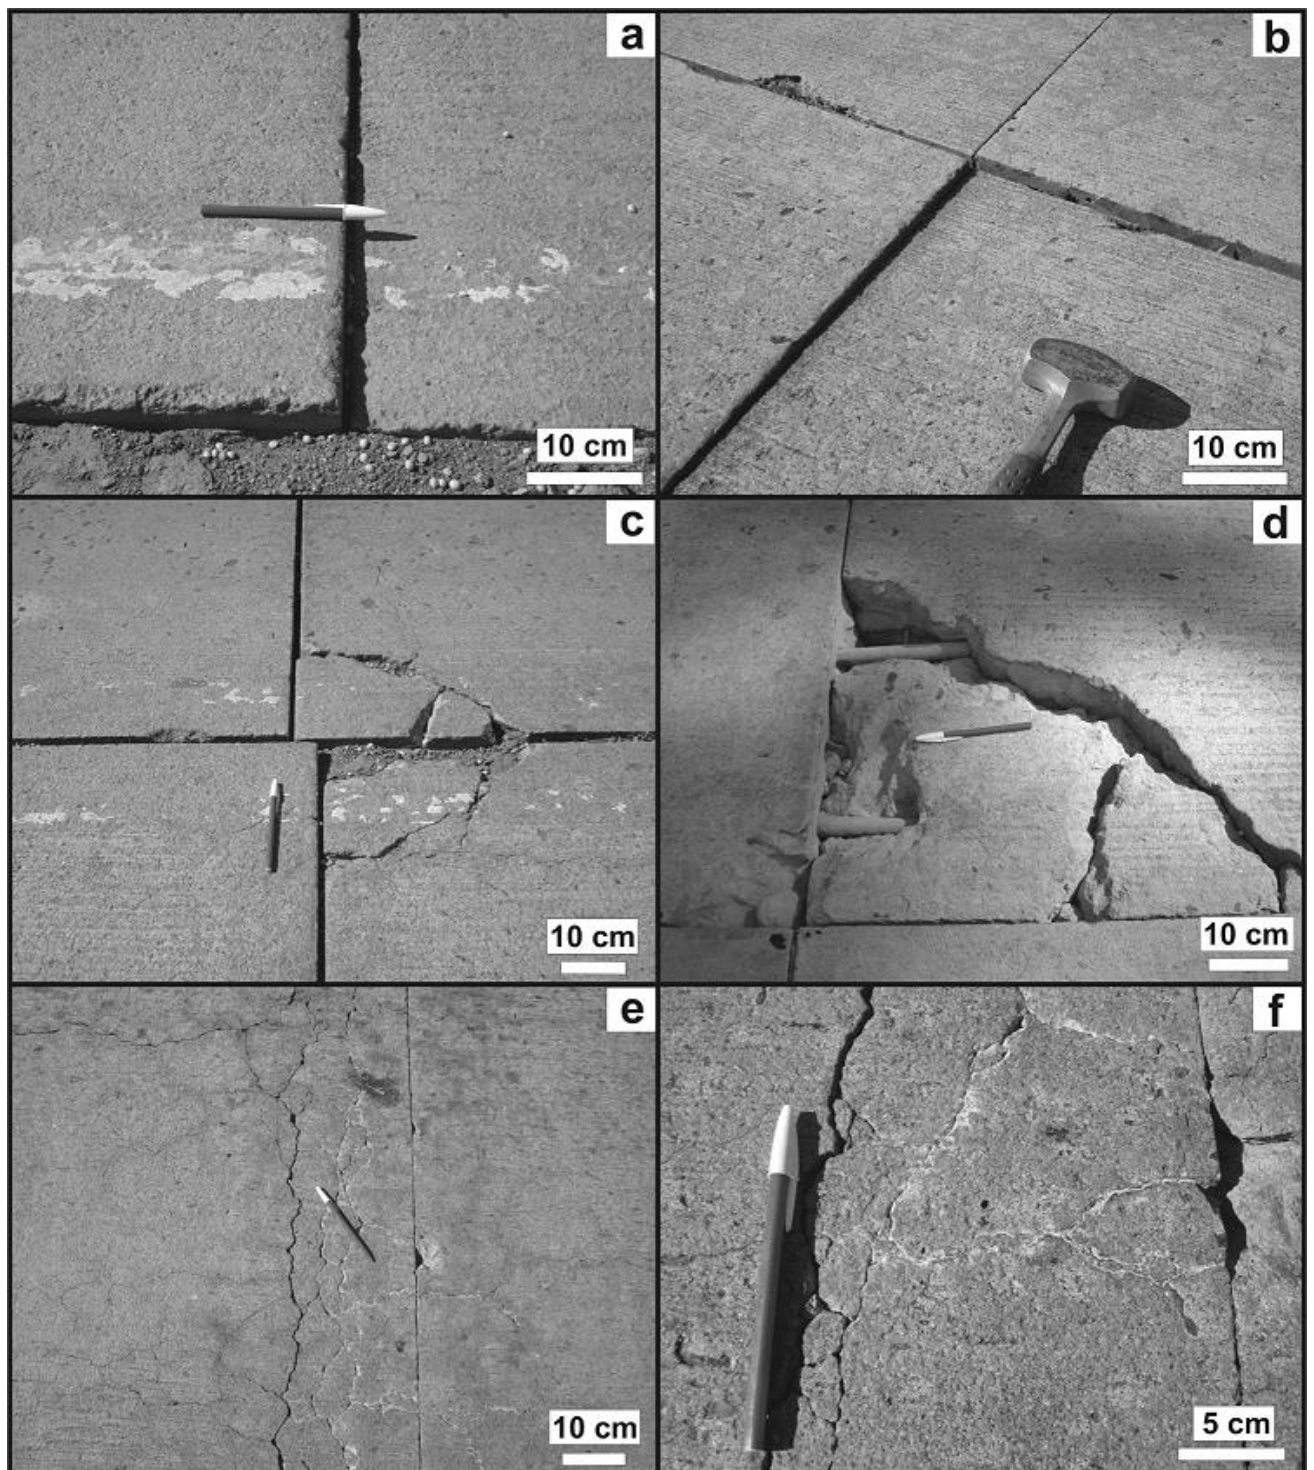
Fotografías de la estructura. a y b) Escalonamiento de las losas. c) Losas dislocadas y ruptura de las esquinas. d) Ruptura de losas en la zona de pasadores. e) Zona fisurada en el sector de junta. Se observan fisuras de primer orden paralelas a la junta, no rellenas y de mayor apertura, y otras de segundo orden en forma de mapa, con paredes
